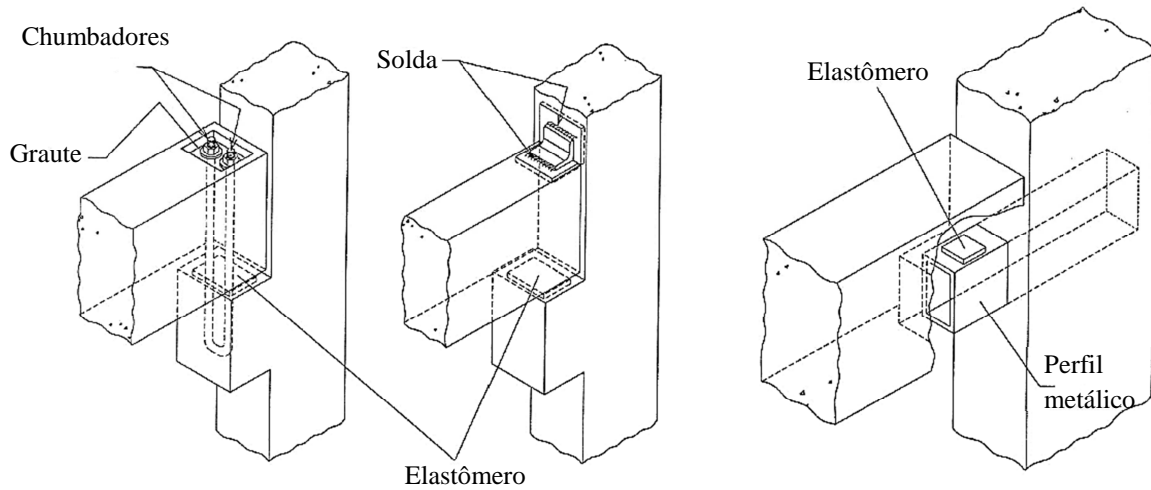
Ligações viga - pilar articuladas [EL DEBS (2000)].
